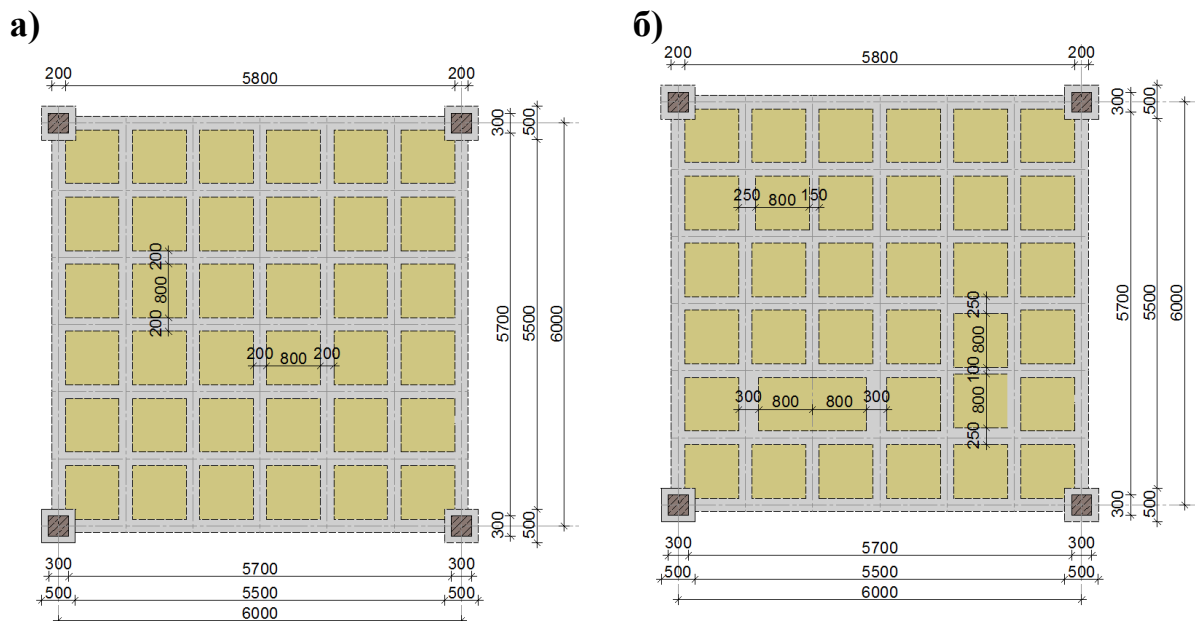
Плита перекриття з нормальним планом (а) та з відхиленнями (б)
